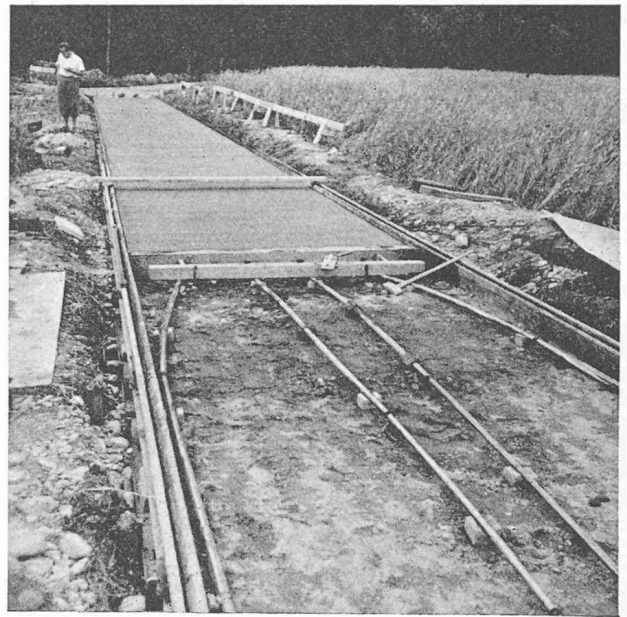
Tronçon II. Arrêt de bétonnage journalier au droit d'un joint actif: les câbles latéraux dans la partie non bétonnée sont déplacés provisoirement.
